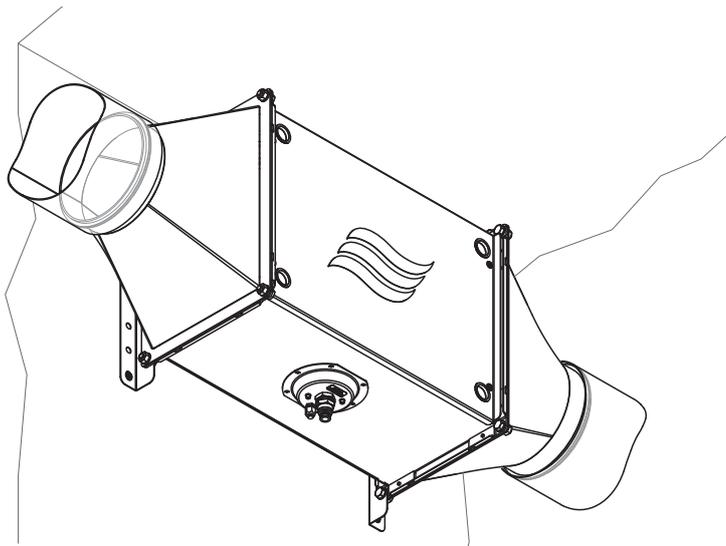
Befeuchtergehäuse an den Gewindestangen befestigen
